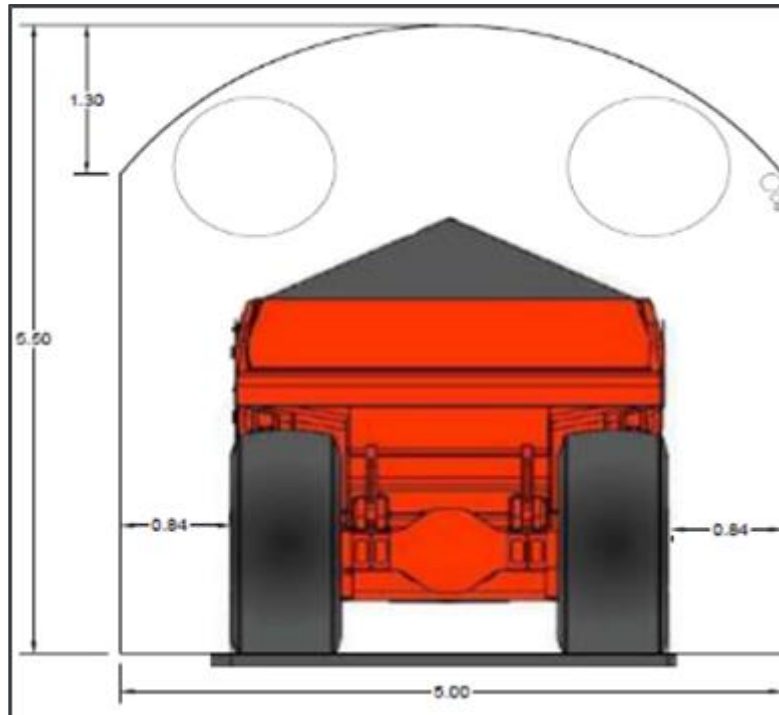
Dimensiones de la Sección Transversal de la Rampa del PMLL
